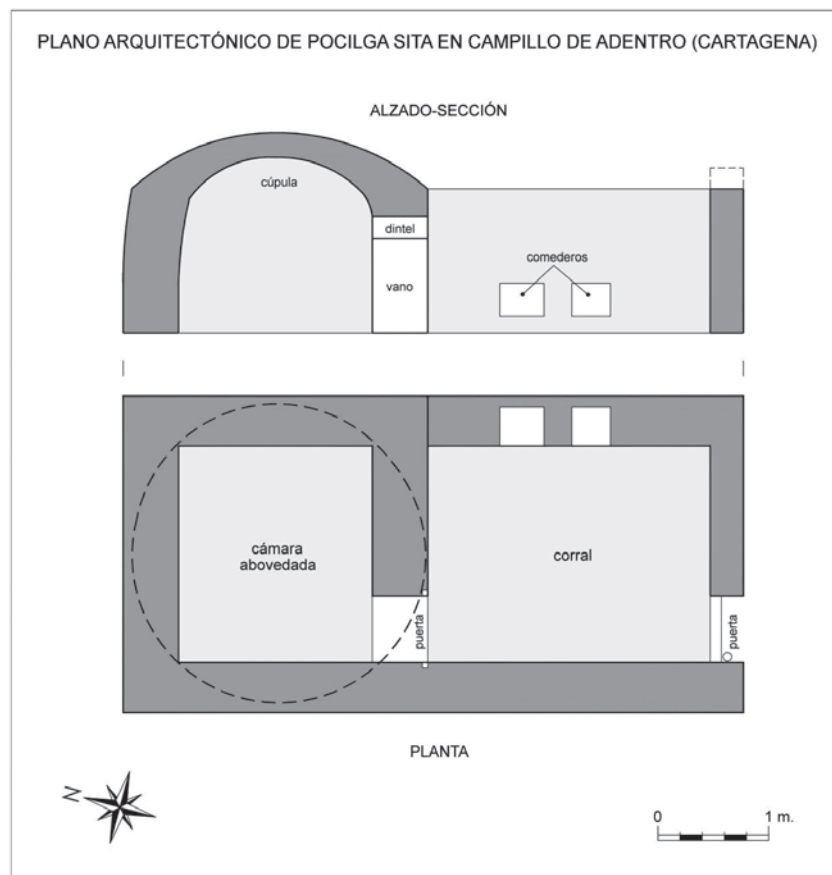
Plano con la planta y el alzado-sección de una de las pocilgas estudiadas.
